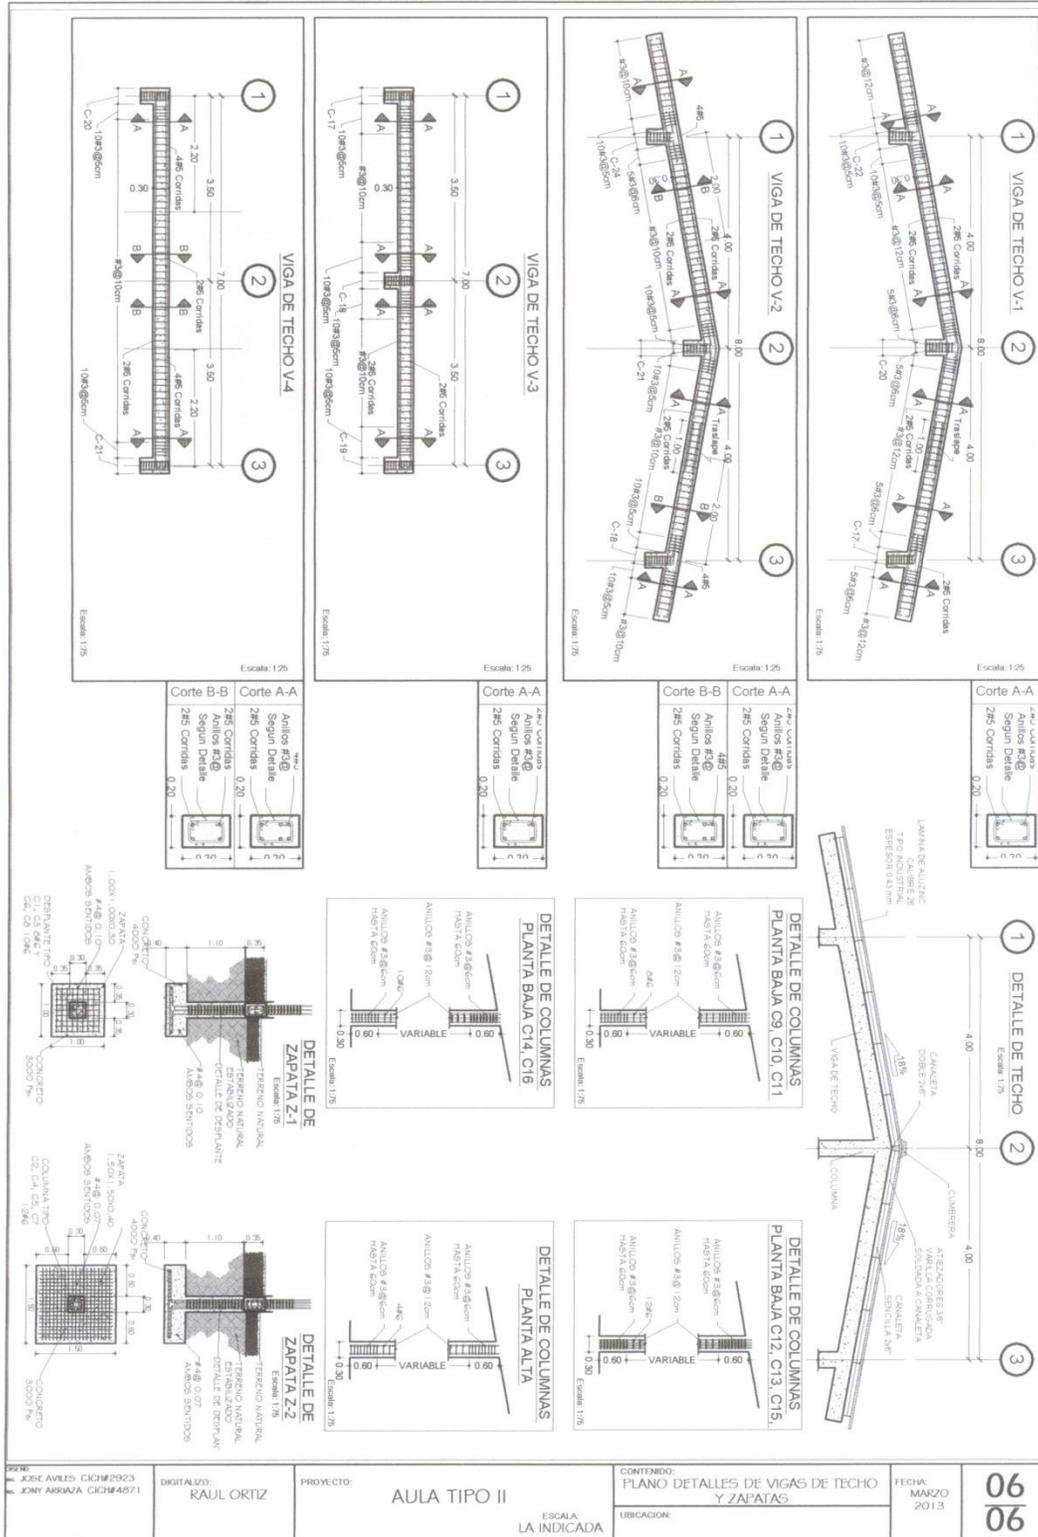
Plano de Estructural de Techo Centro Escolar Aula Tipo II Niveles 7X8m.
